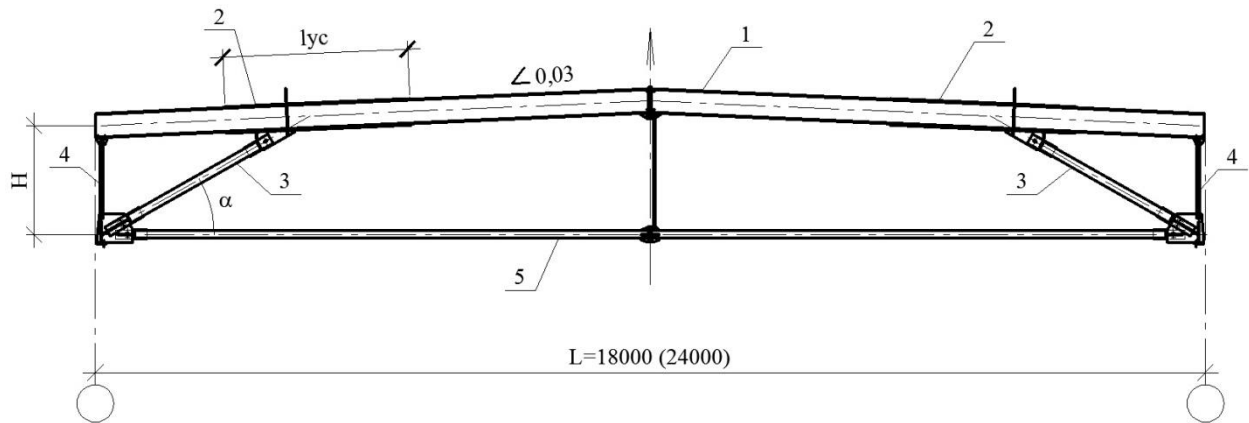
Стропильная конструкция покрытия в виде балки переменной жесткости с подкосами и затяжкой: 1 – балка; 2 – усиление балки над подкосом; 3 – подкос; 4 – надколонник; 5 – затяжка
